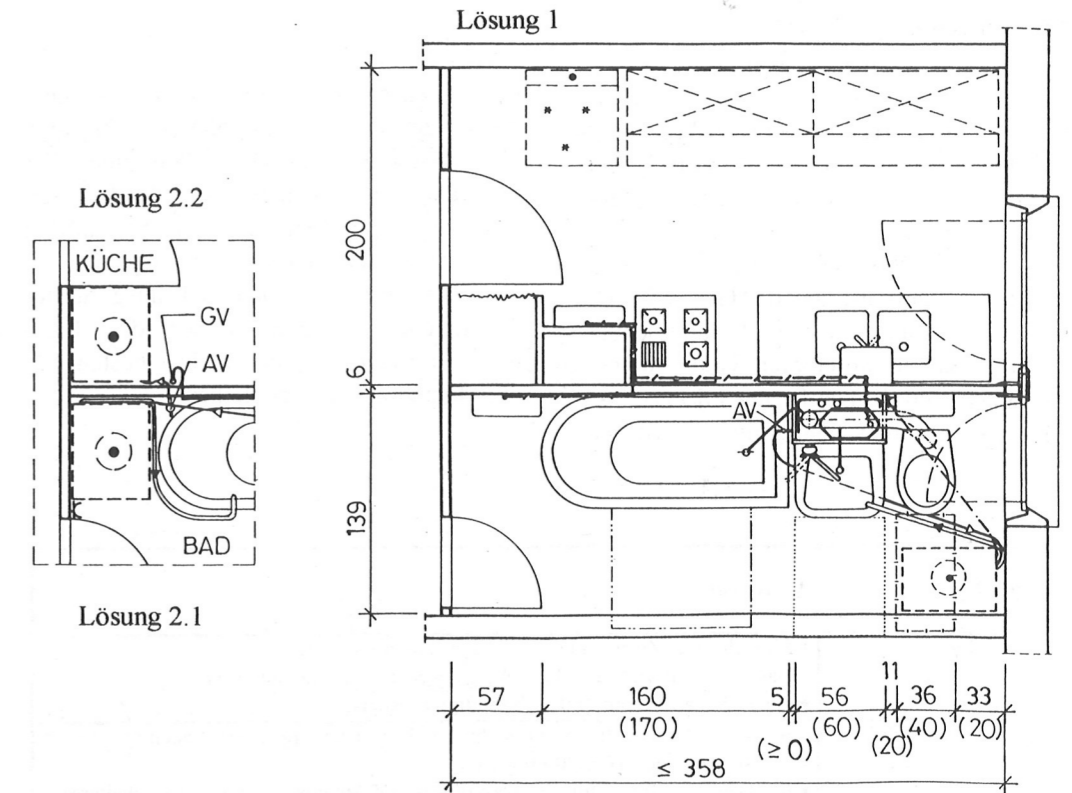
Vorhandene Grundrißlösungen Außenküche/Außenbad
